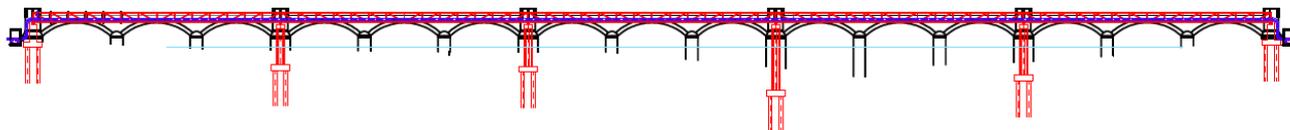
Sezione longitudinale attraversamento aereo di progetto sul Fiume Sangro.
